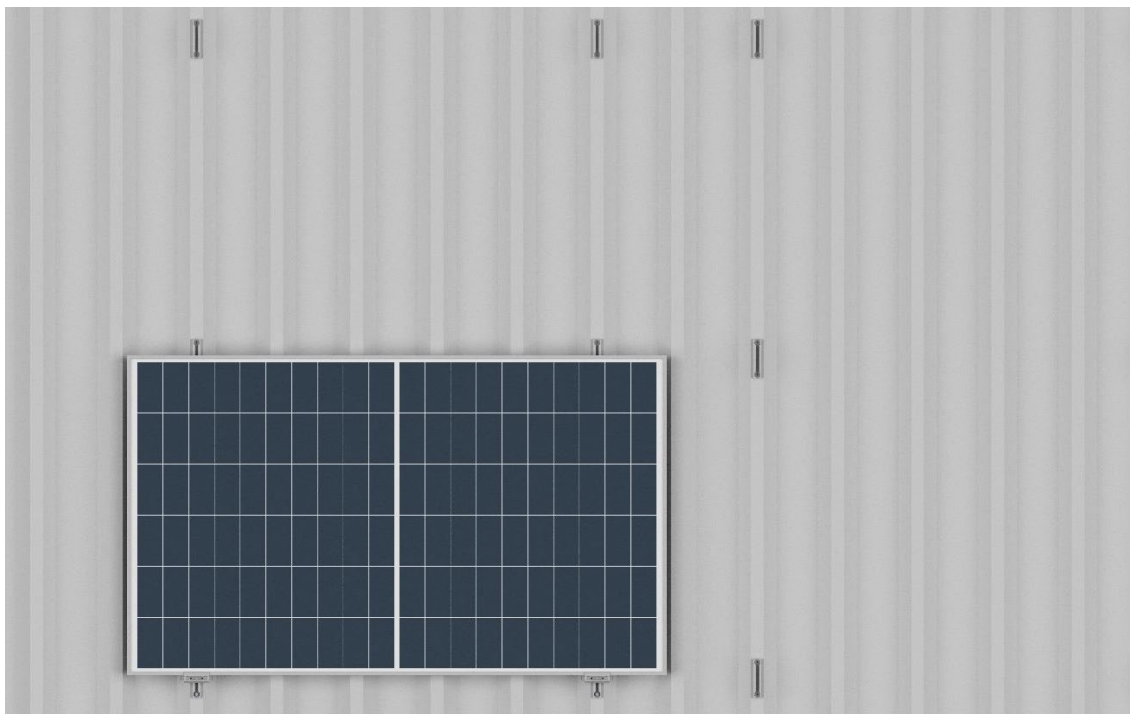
Montaż „systemu trapezowego Eco 120 mm”
